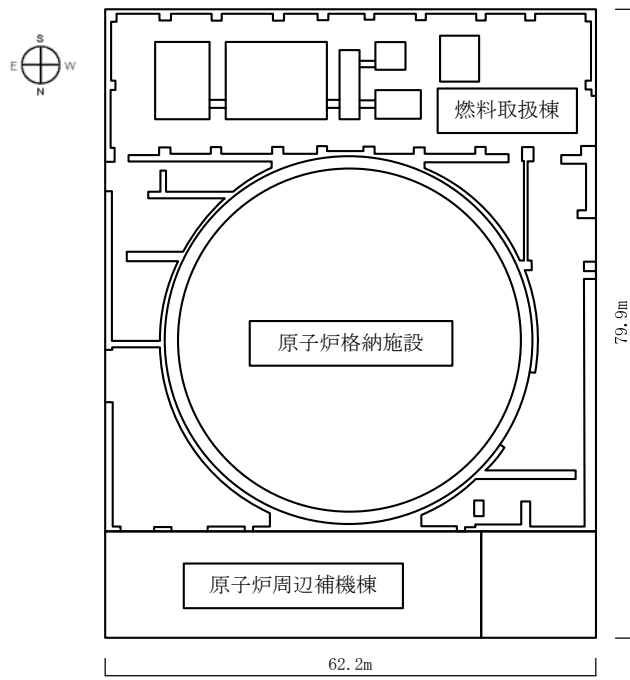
原子炉建屋(E. L. 32. 3m) 平面図
